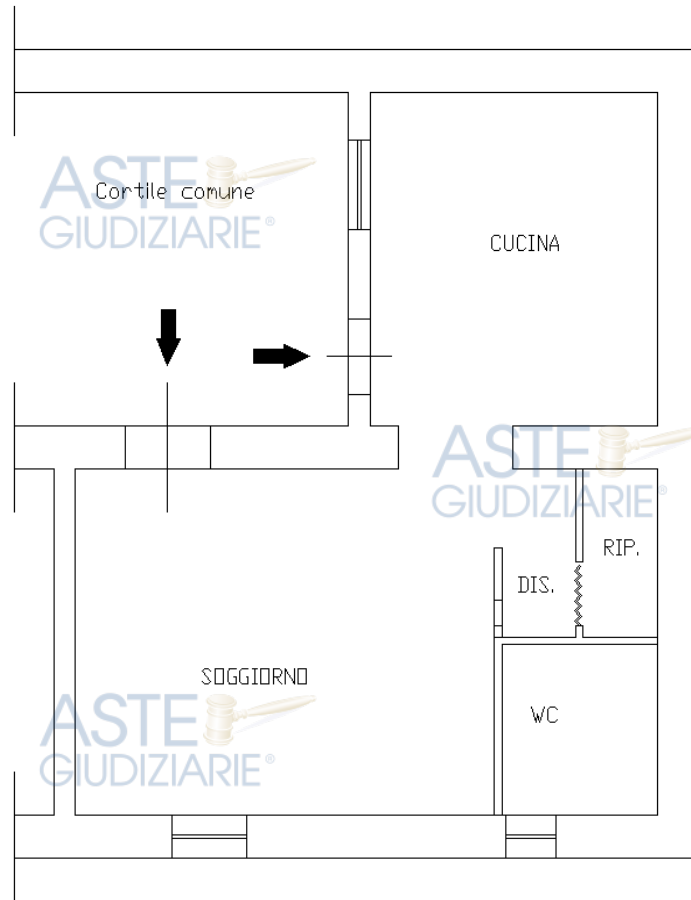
Planimetria dell'appartamento al piano terra oggetto di pignoramento- interno 2
